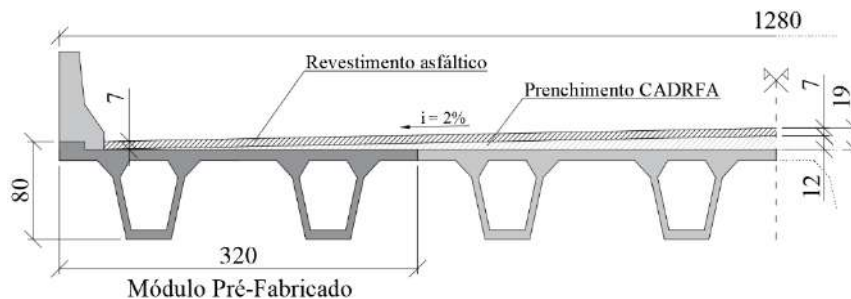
Seção transversal da concepção estrutural, dimensões em cm.
